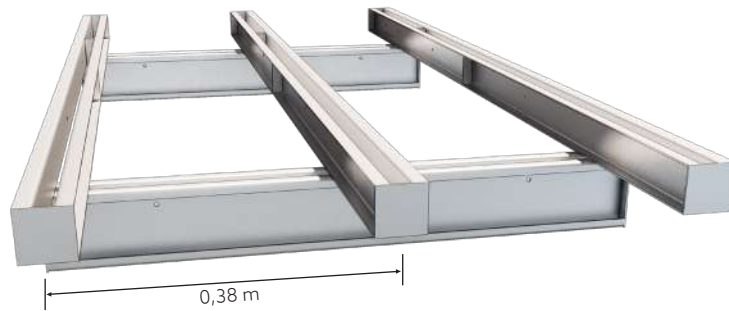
Perfil secundário C7,5 SH apoiados sobre metro do perfil primário C12 SH
